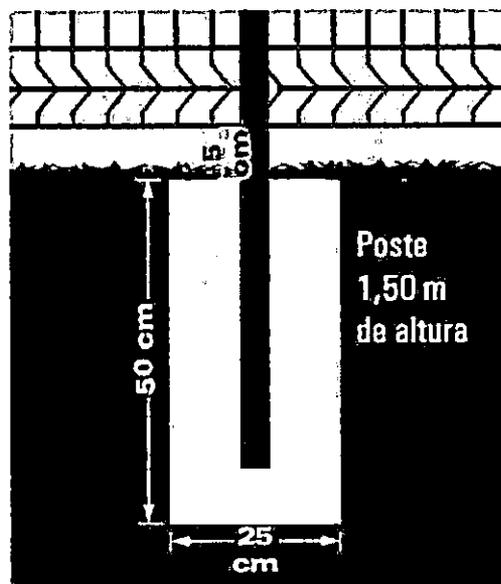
Ilustração de poste de gradil chumbado em concreto.
